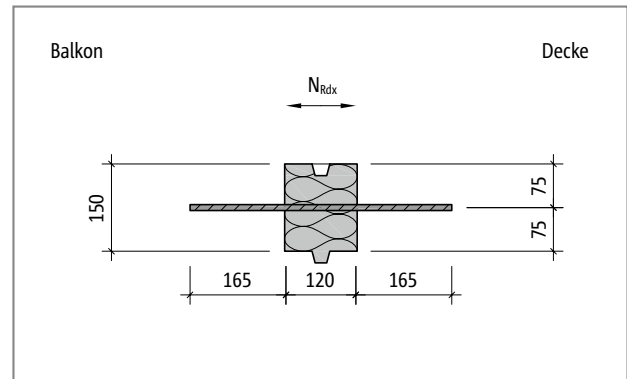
Schöck Isokorb® XT Typ HP-NN1: Produktgrundriss
